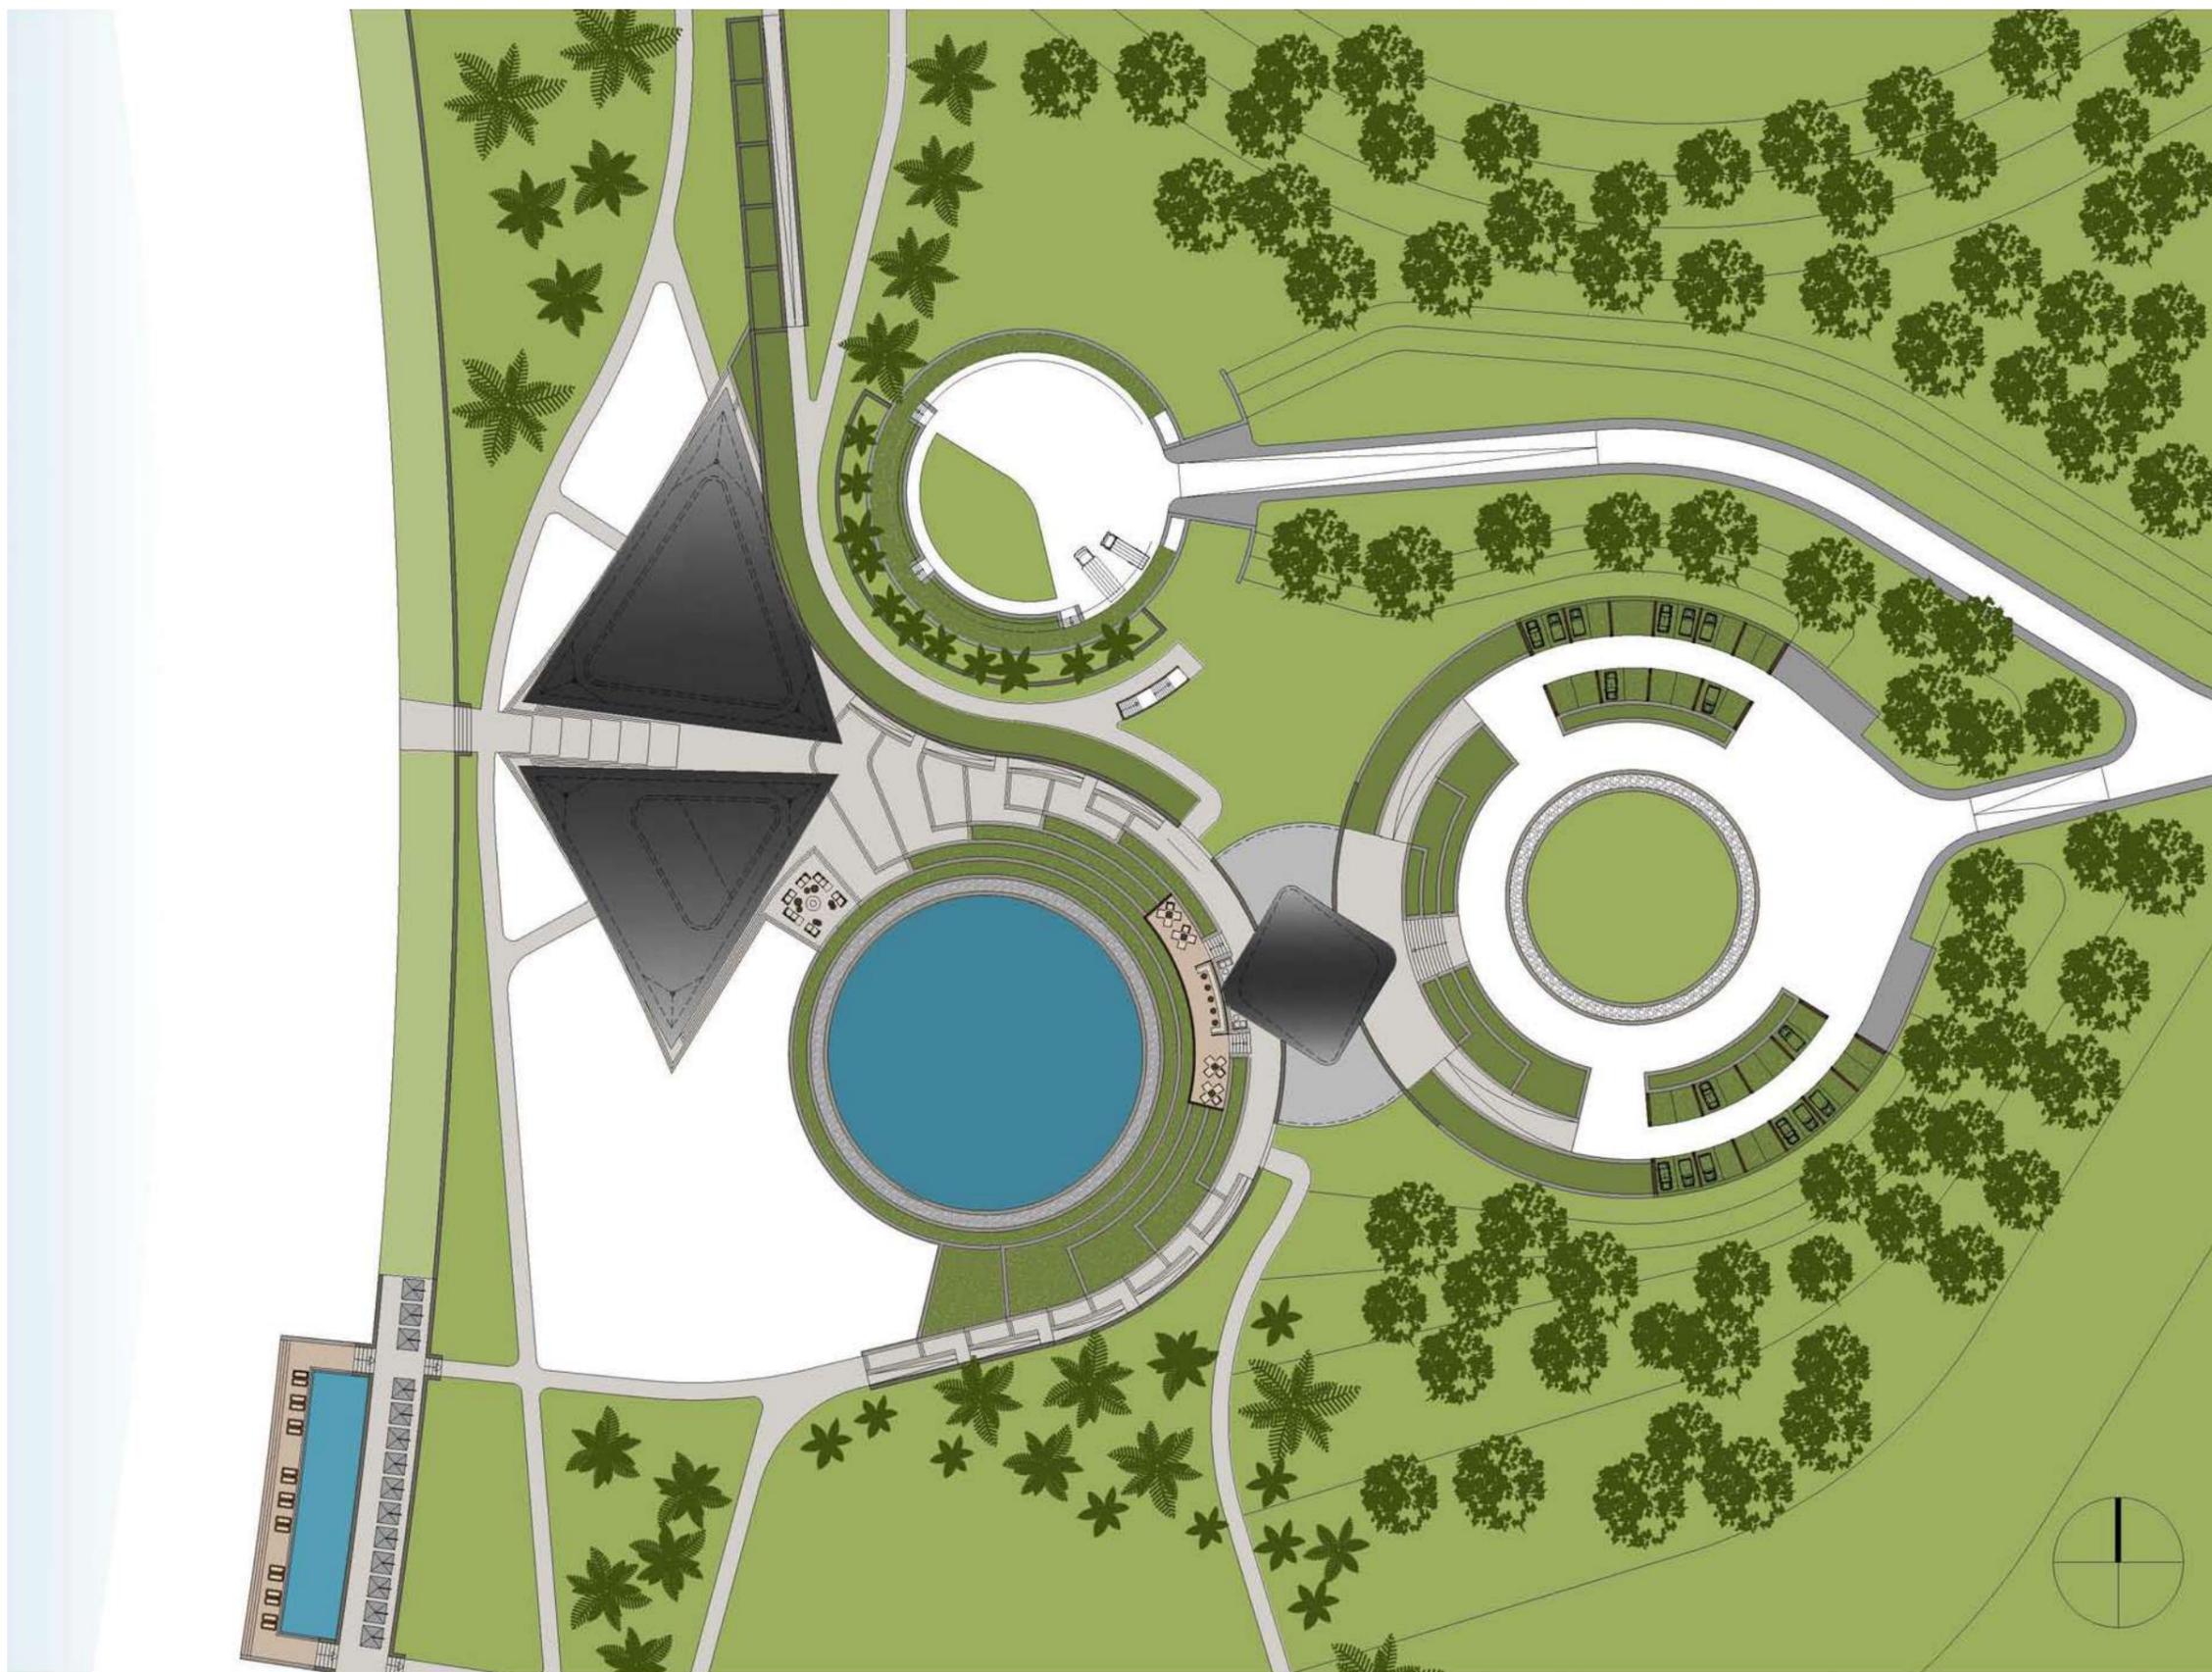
Grundriss Hauptgebäude Dachdraufsicht
